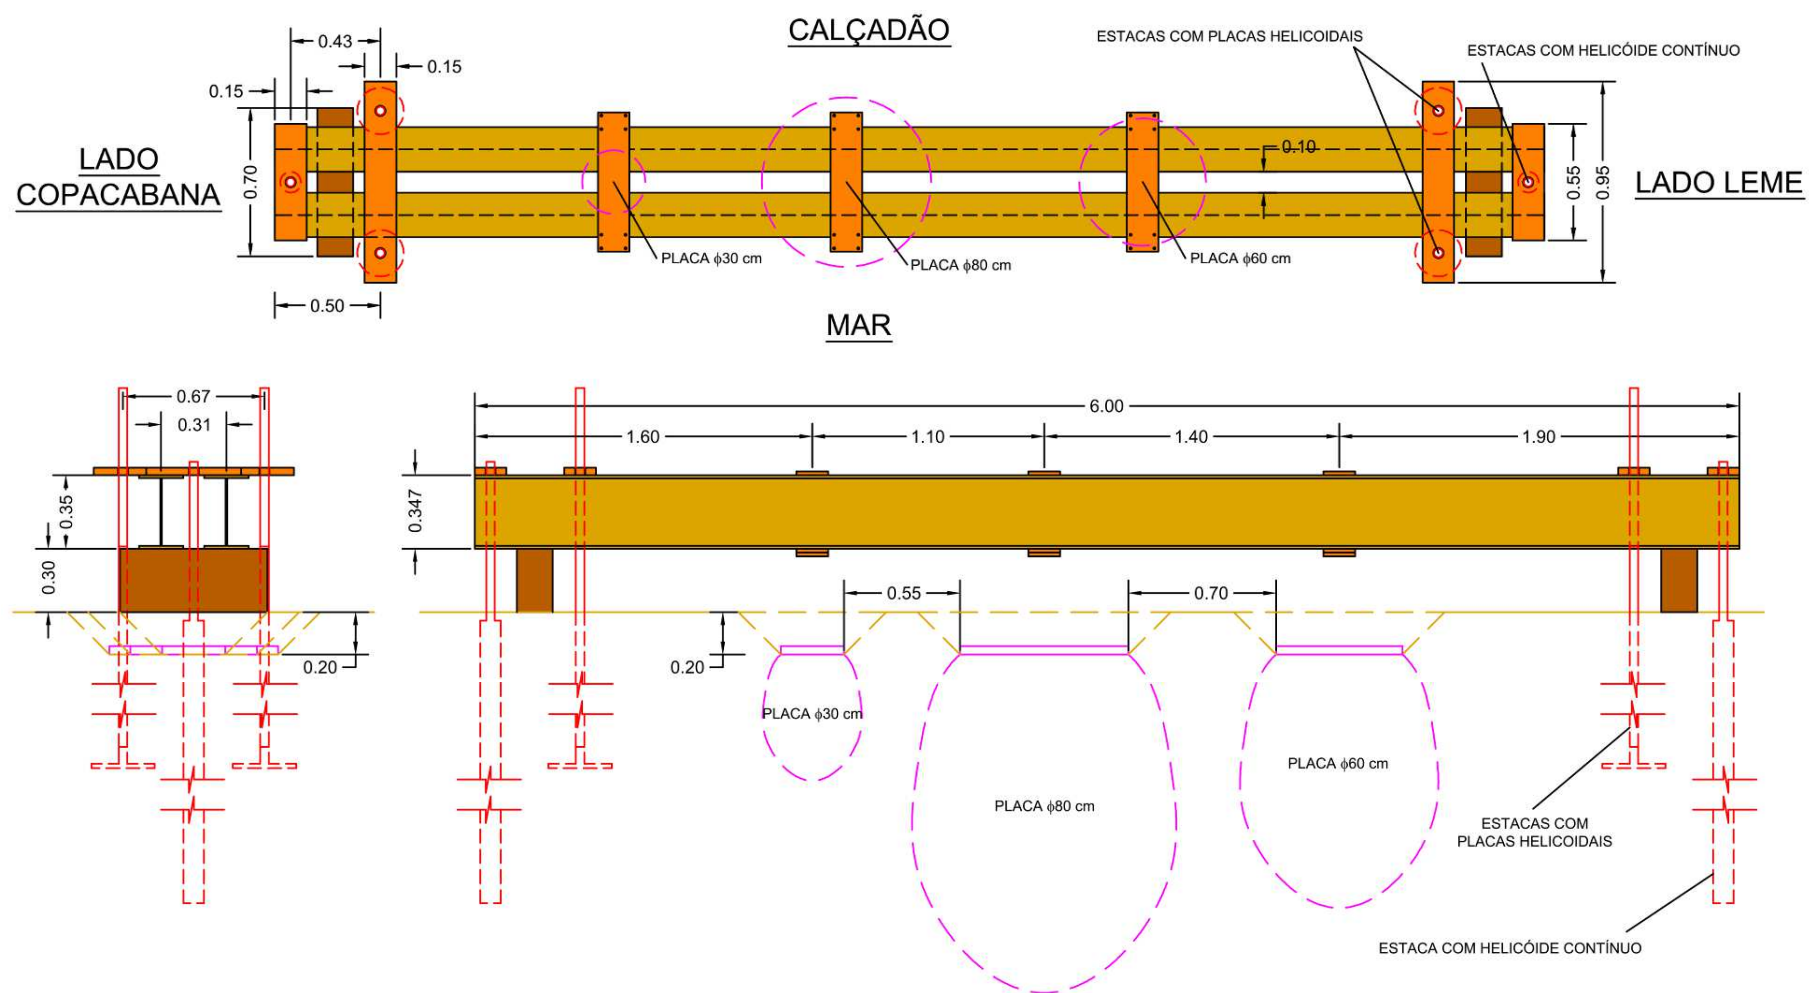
Arranjo das provas de carga – Planta e cortes – Cotas em metros (Gomes, 2016).
